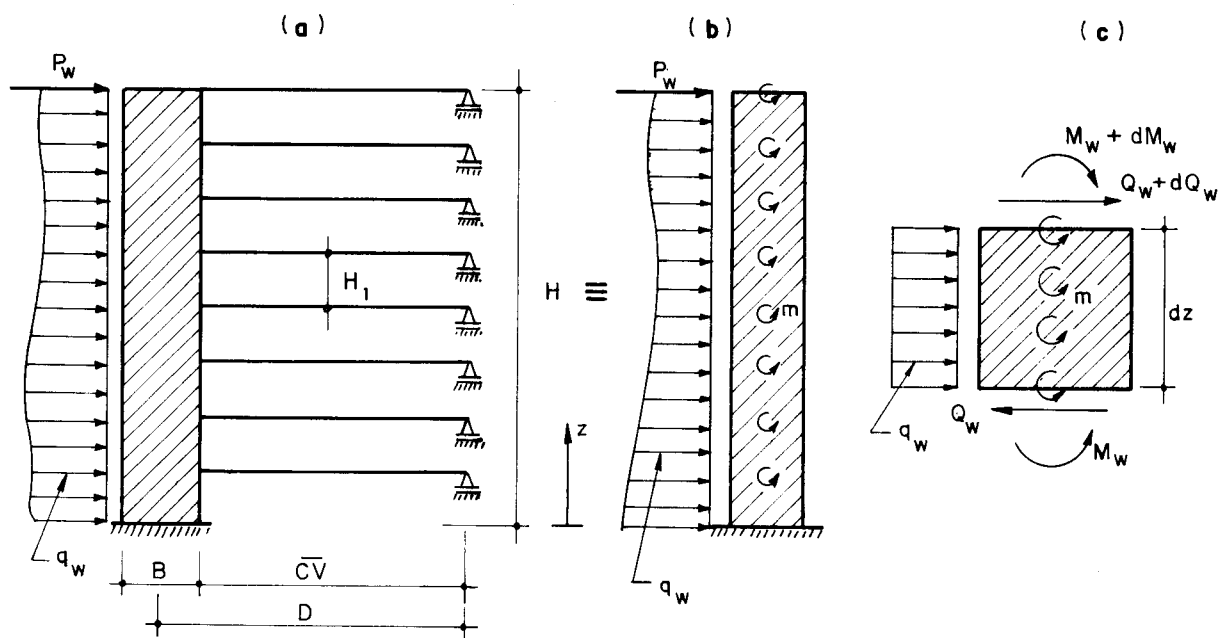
Painel com um pilar-parede e lintéis simplesmente apoiados na outra extremidade
